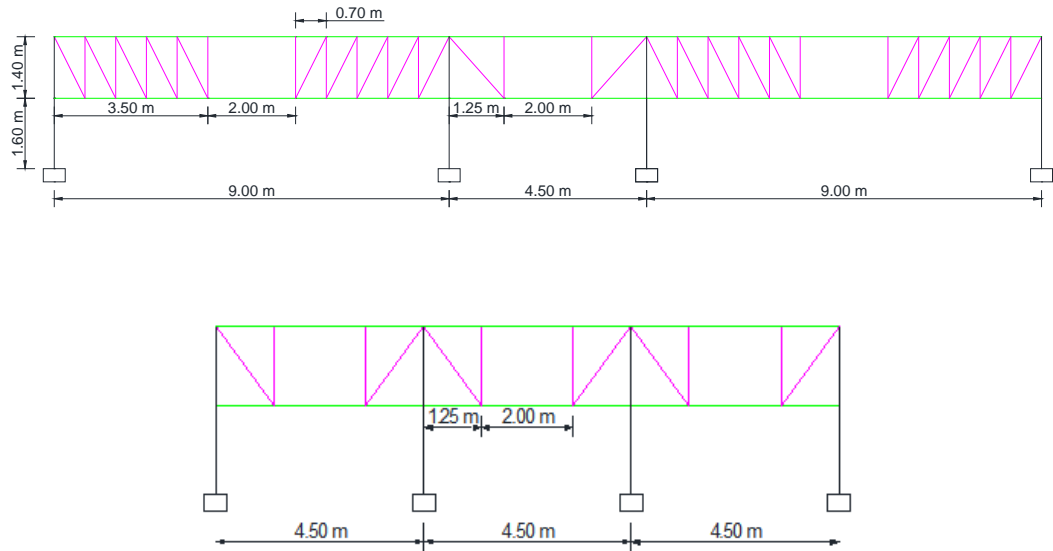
Configuración de los pórticos con viga reticulada y el segmento especial Vierendeel en la dirección Y.
